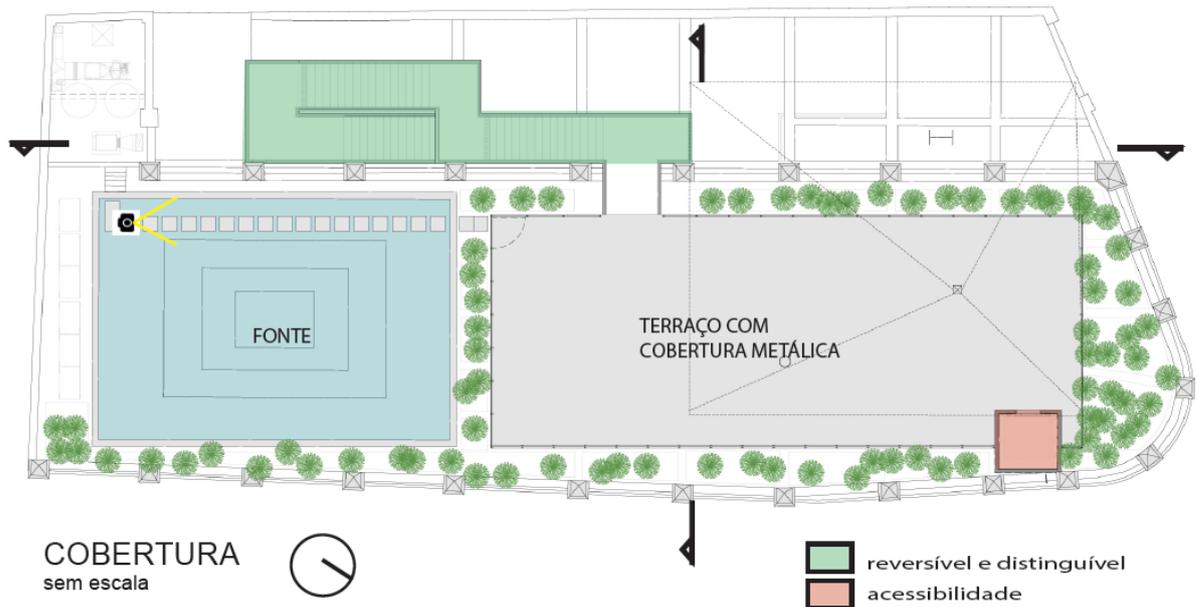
Planta da Cobertura do Centro Cultural *Red Bull Station* (ARCHDAILY, 2013)
